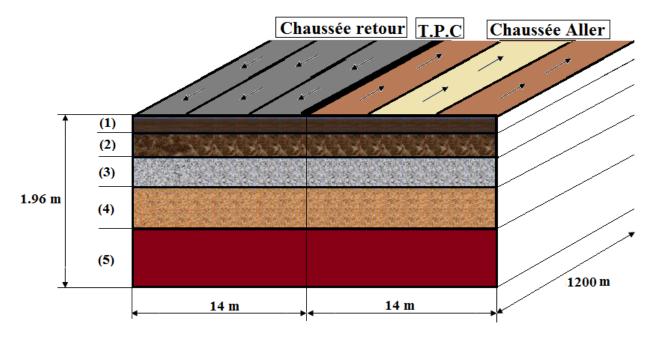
Différentes couches constituant la chaussée autoroutière endommagée (chaussée-aller).
